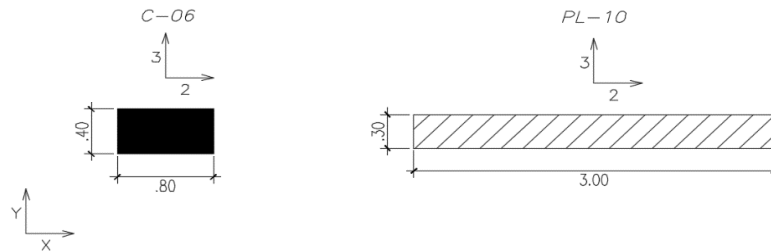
Ejes globales y locales para columna C-06 y placa PL-10
